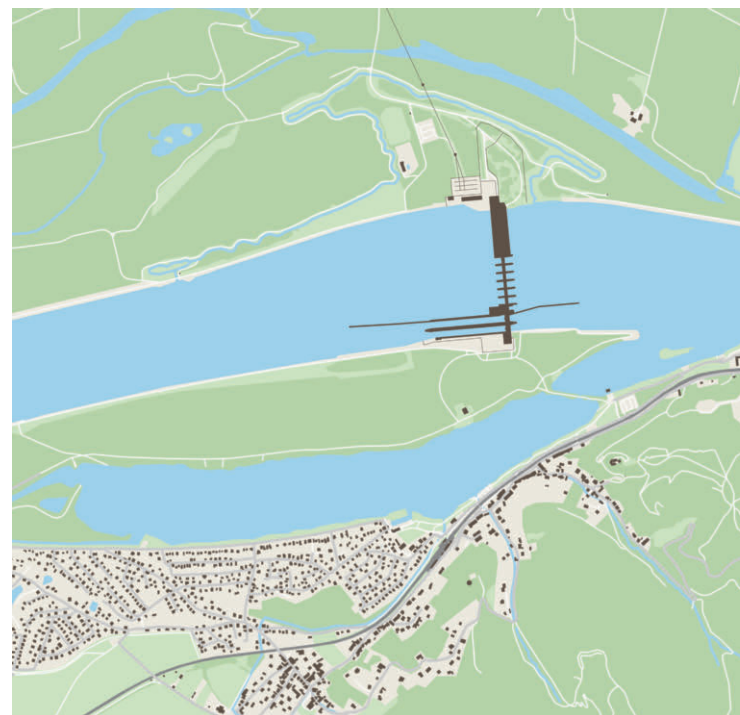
Laufkraftwerk Greifenstein, Lageplan, 2024
